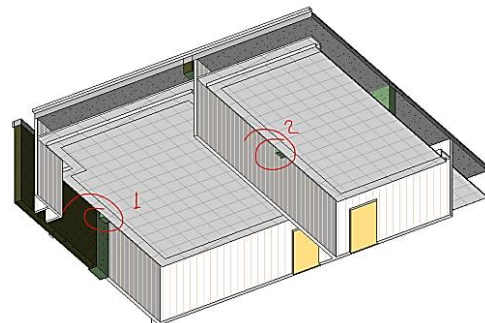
Viga de concreto expuesta bajo la cenefa y FCR.
